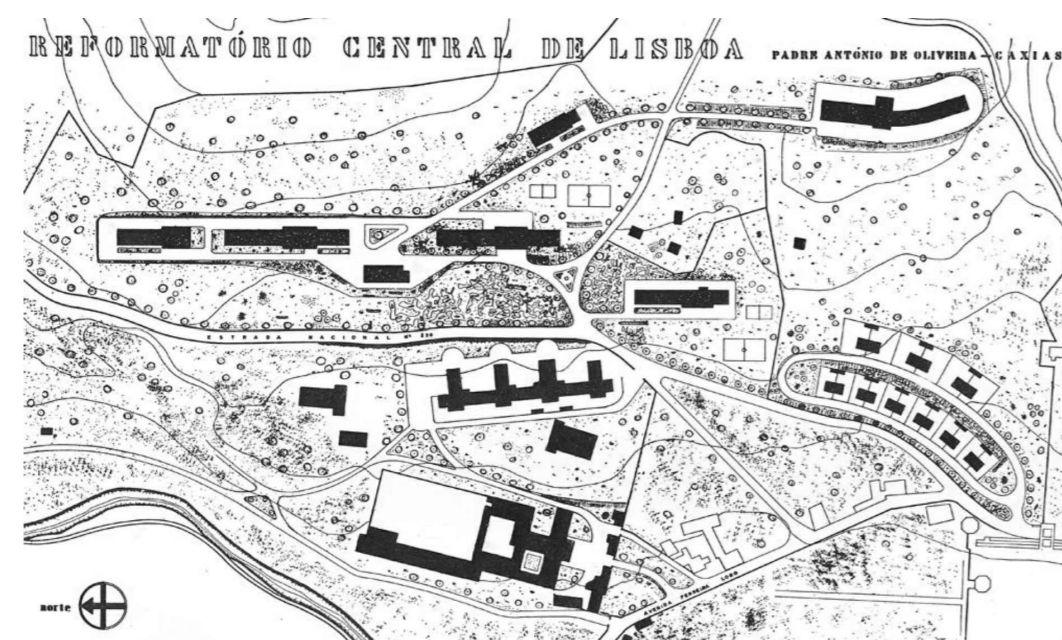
planta geral das instalações pré-existentes e propostas, 1949
